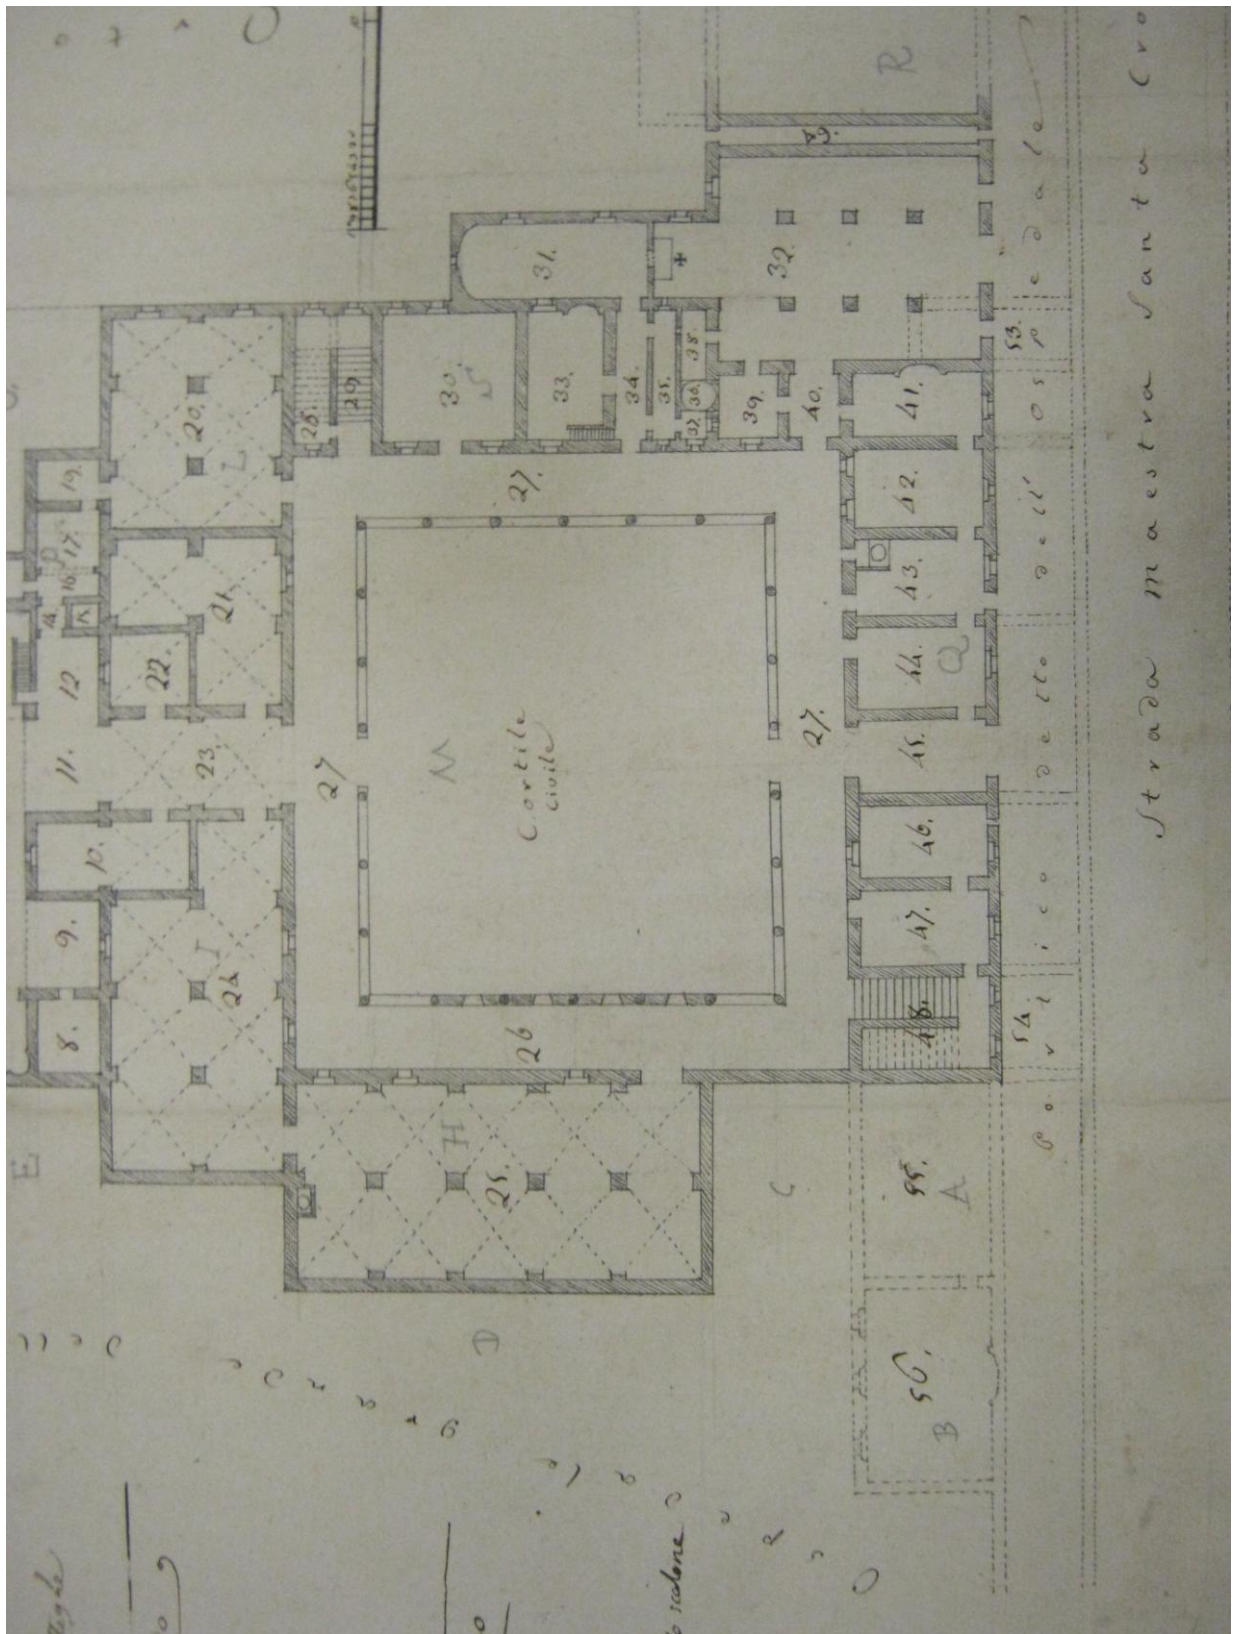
particolare della planimetria del Pian Terreno dell'Ospedale degli Esposti, 1806 (Archivio di Stato di Parma).
